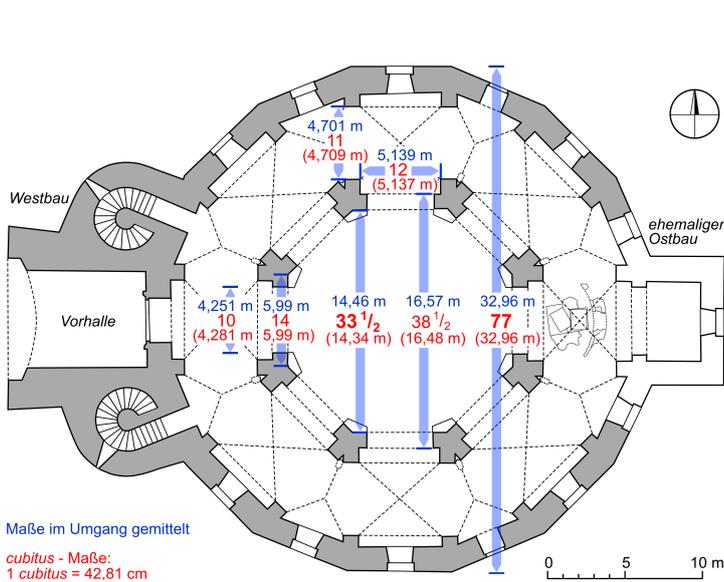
Der Grundriss der Aachener Marienkirche im Erdgeschoss
